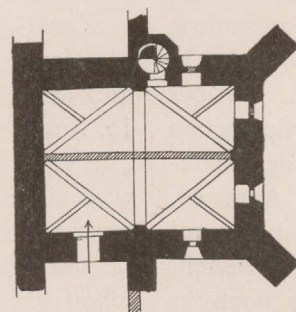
Kath. Pfarrkirche zu Christburg. Grundriß der Unterkirche.
